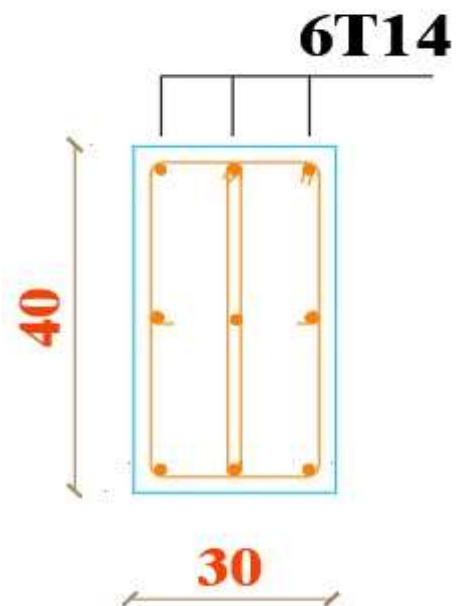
Ferrailage poutre principale et poutre secondaire
